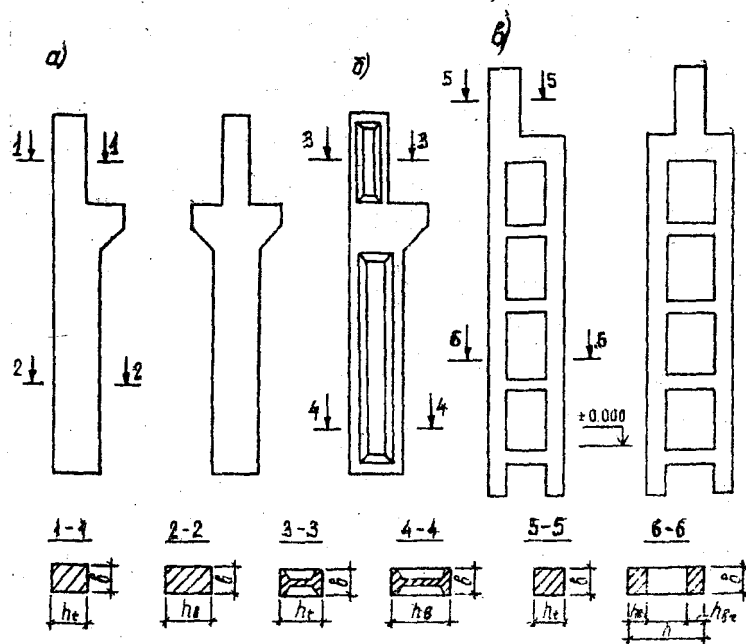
Колонны ПОЗ с мостовыми кранами: а) прямоугольного сечения; б) двуглавового сечения; в) двухветвевые крайние и средние
